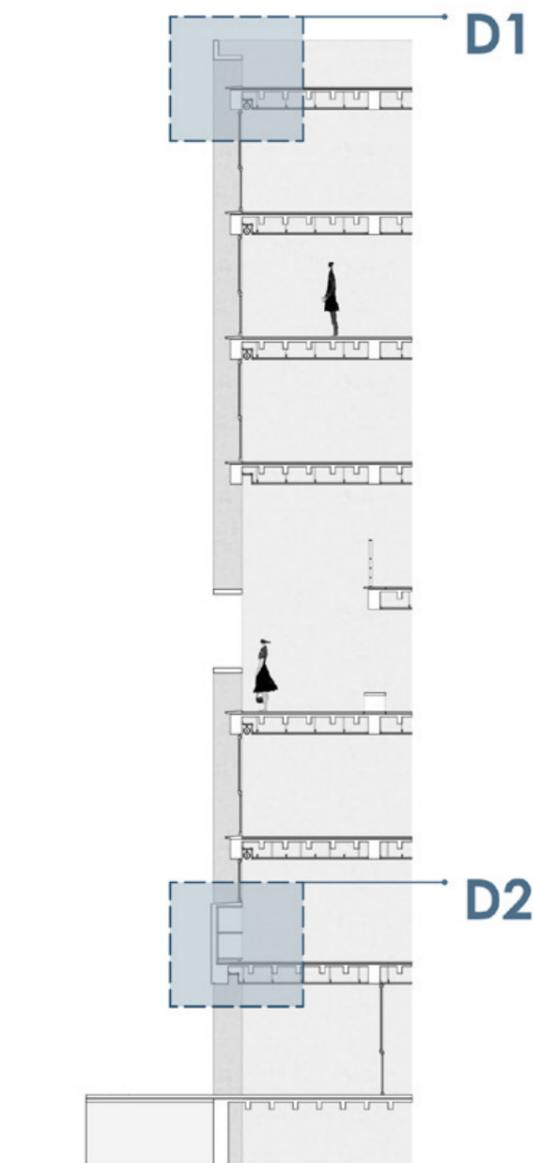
Sección constructiva correspondiente a la fachada de la calle Simón Bolívar. Fuente: Elaboración propia.
